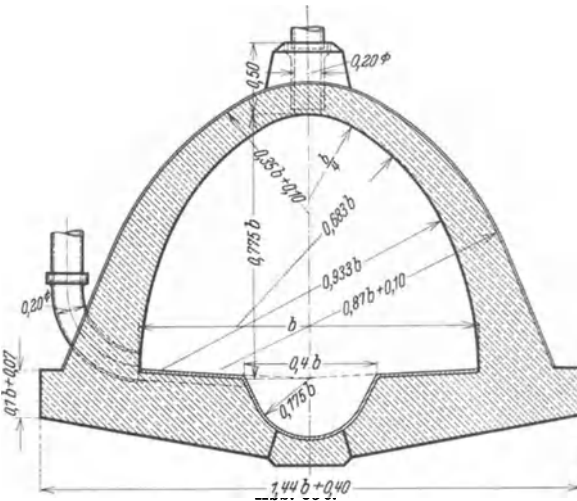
bis f. Profile aus Beton und Eisenbeton bei verschiedenen Kanalisationsverwaltungen.
